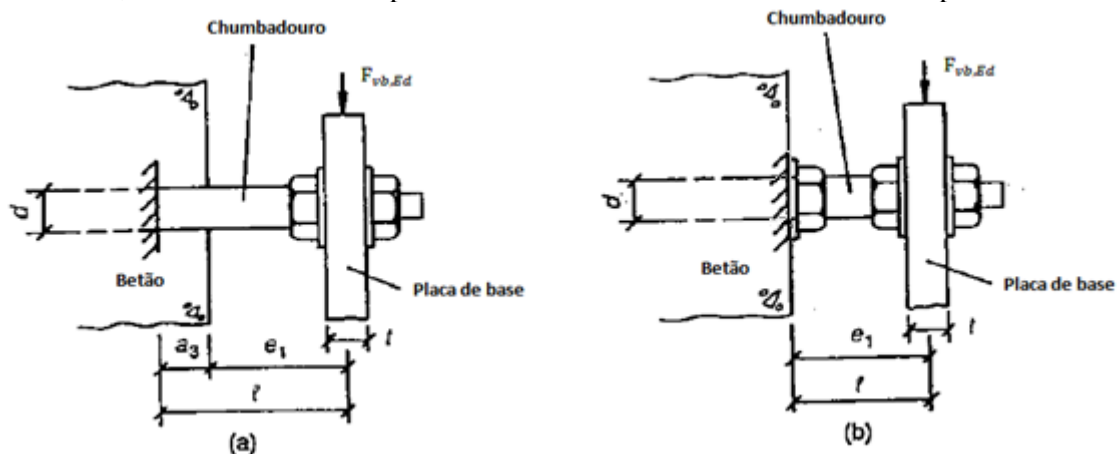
Esquema estrutural do chumbadoro para força horizontal na placa de base
